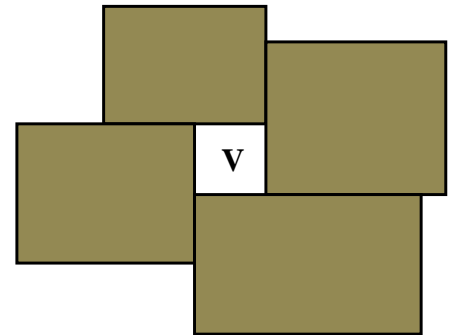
b : vide engendré par l'assemblage de blocs de différentes dimensions.
